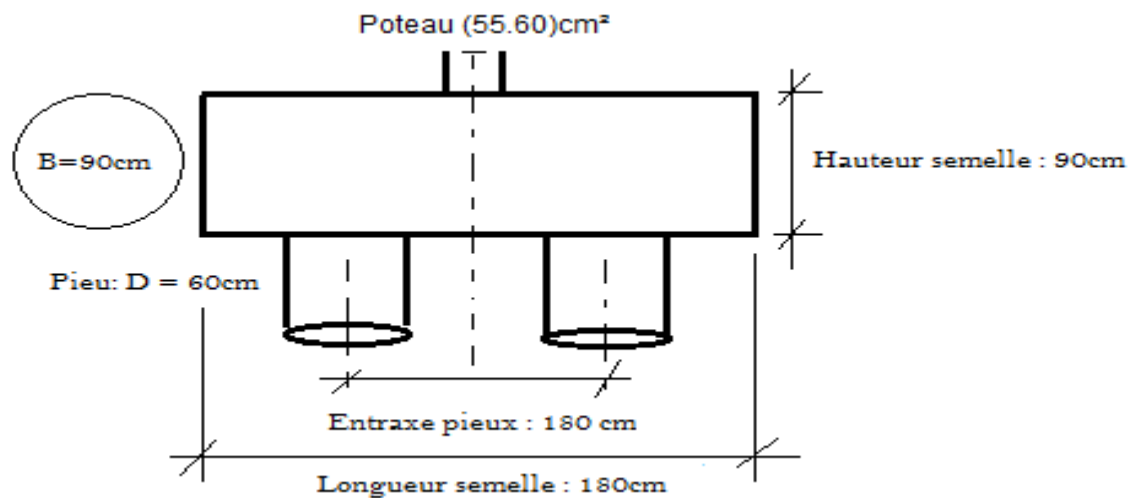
Dimensions de la semelle sur deux pieux.
